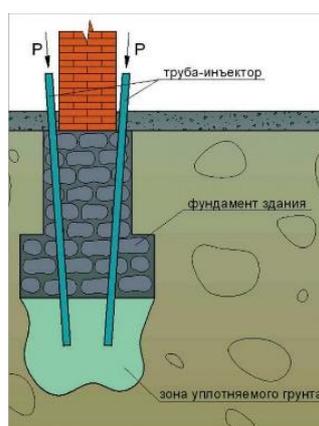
Нагнетание раствора жидкого стекла под фундамент
